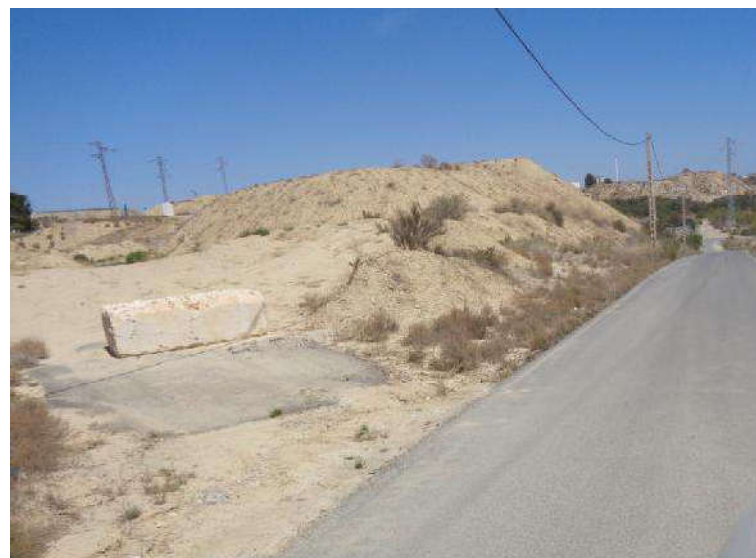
Delimitación del sector DP 02 en la zona sur con un camino asfaltado, vista desde el suroeste.
